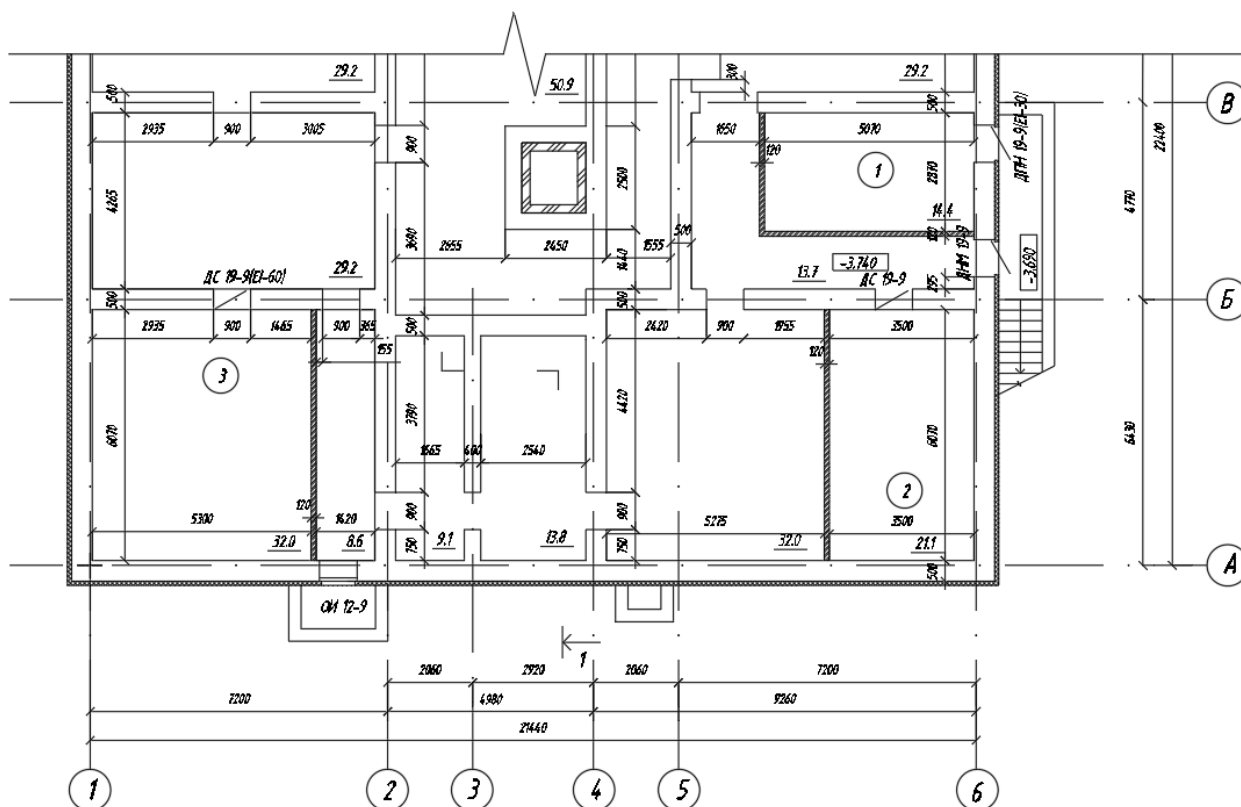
Схема расположения инженерного оборудования в здании (схема технического подвала)
